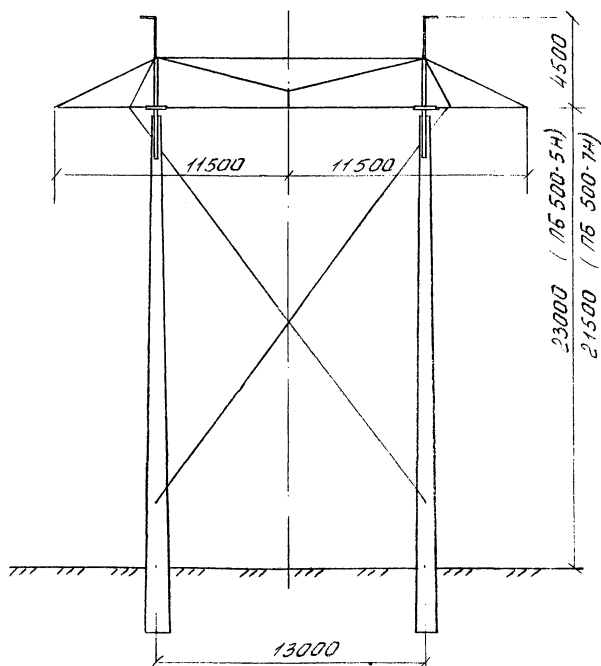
Промежуточные железобетонные опоры типа ПБ 500-5Н и ПБ 500-7Н
